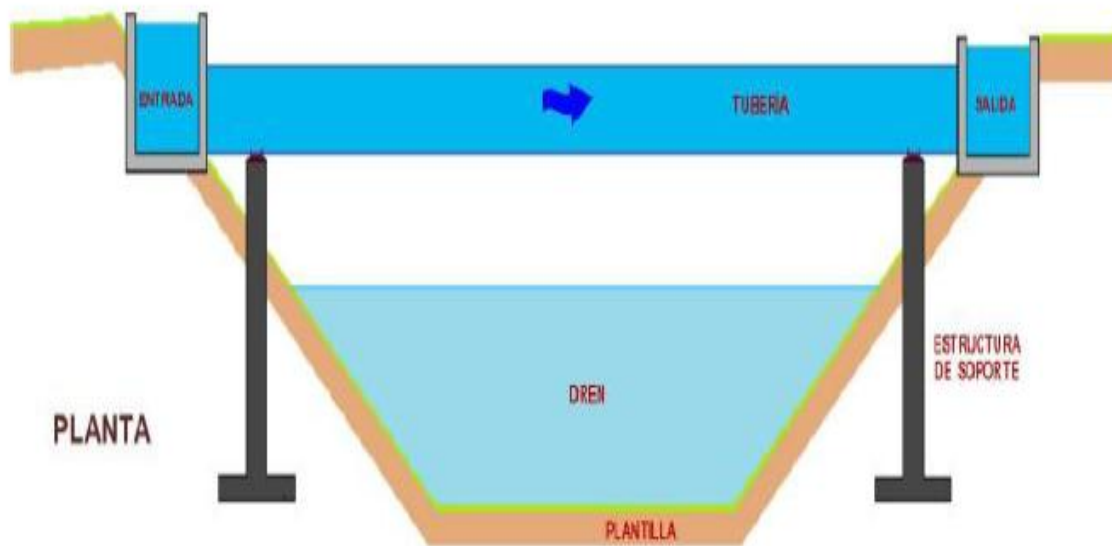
Configuración de un puente canal como obra asociada al proyecto donde se usara cimentación y colado con concreto reforzado y tubo de acero de 36", además colocación de piedra bola en las entradas y salidas del puente canal.
